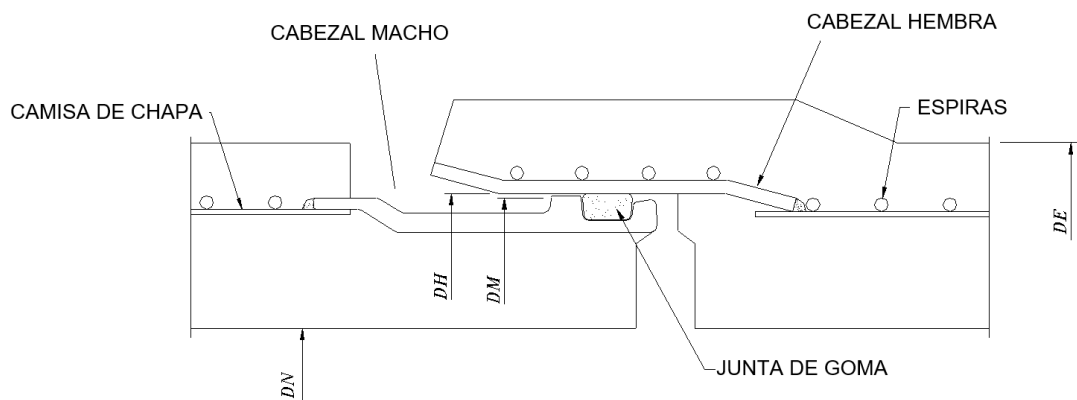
Secciones tipo del tubo de hormigón armado con camisa de chapa con junta elástica y con junta soldada (continuación).
